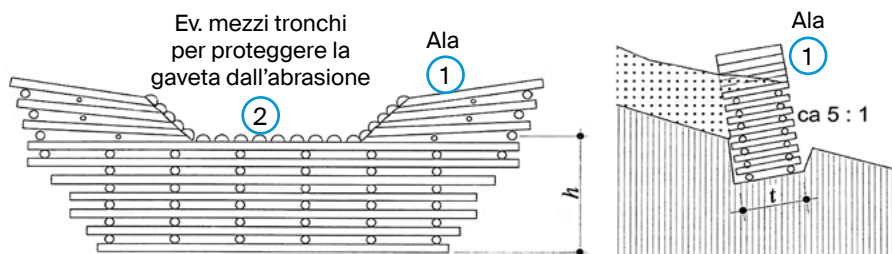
Briglia con cassoni a due pareti in legno: prospetto e sezione (USTRA)
